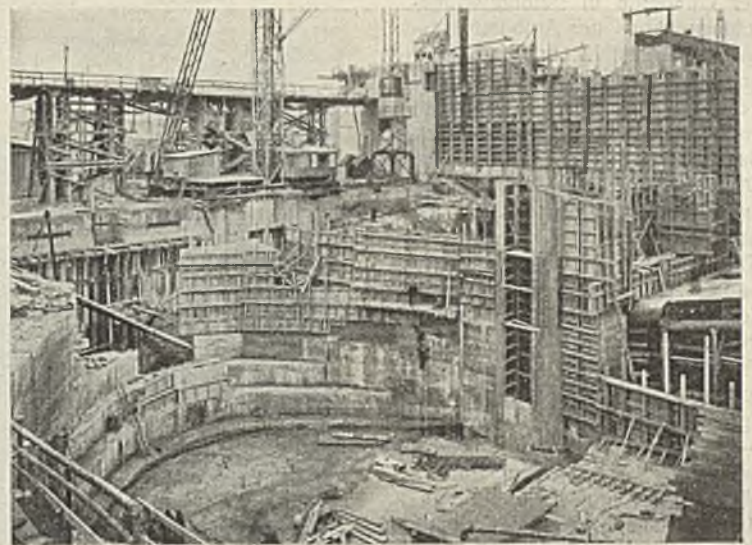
Linke Krafthausbaugrube, Blick vom Unterwasser. Erosionsrinne mit Magerbeton ausgefüllt.
